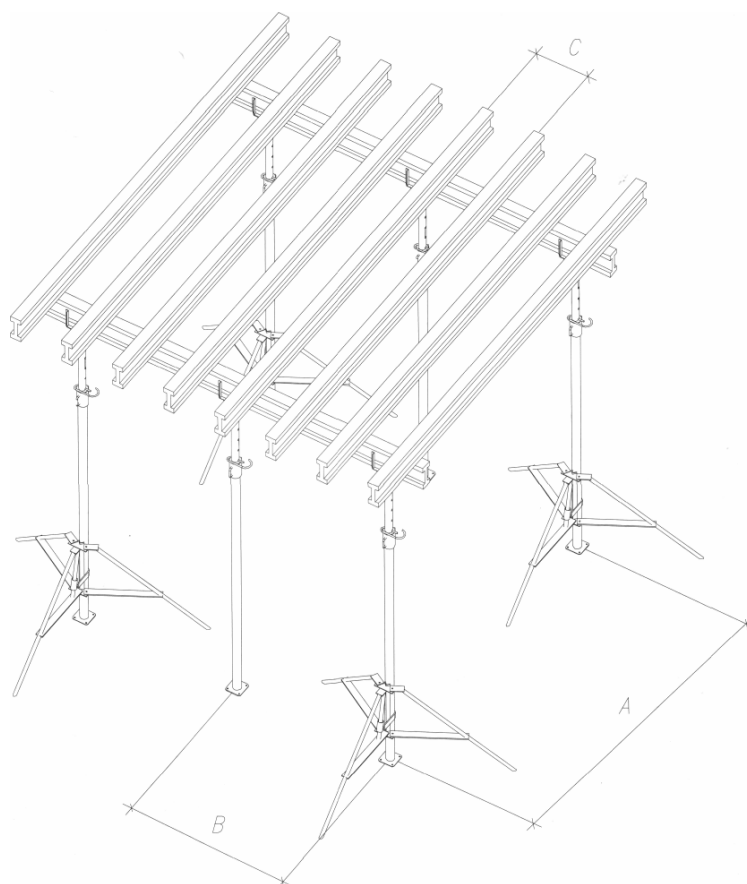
Опалубка перекрытия на телескопических стойках
